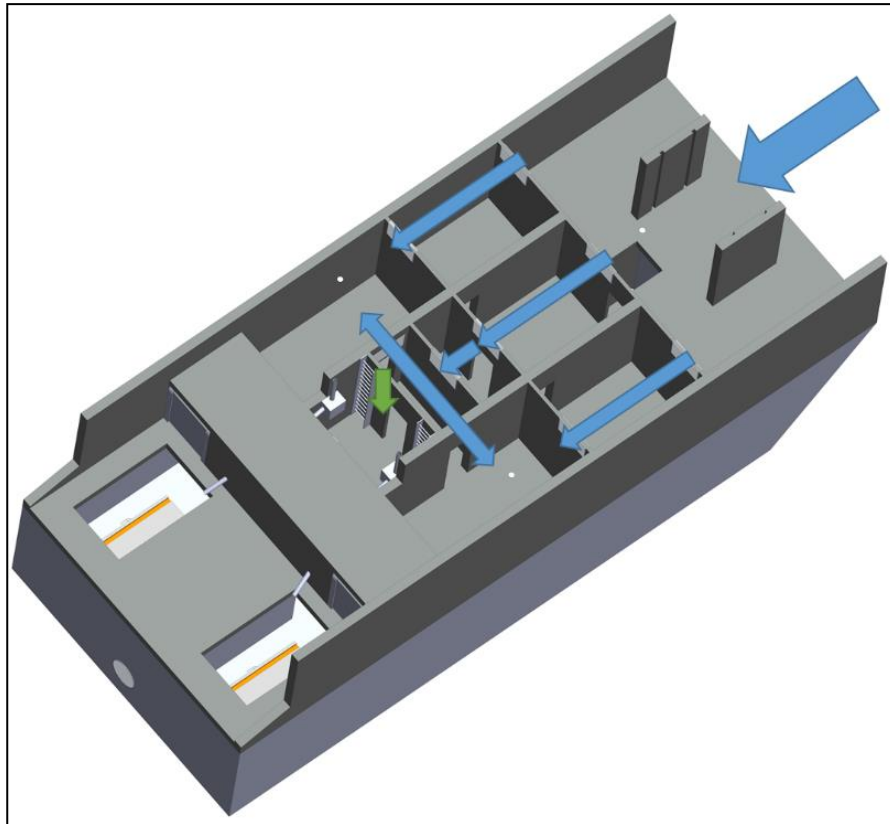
Führung der Frischwetter der Ebene 2 der Schildmaschine
